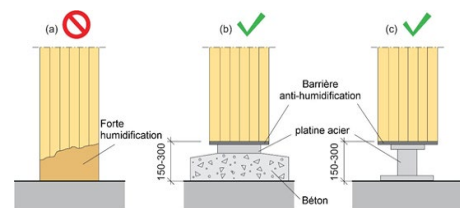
Liaison poteau en bois et fondations (handbook s.d.)
